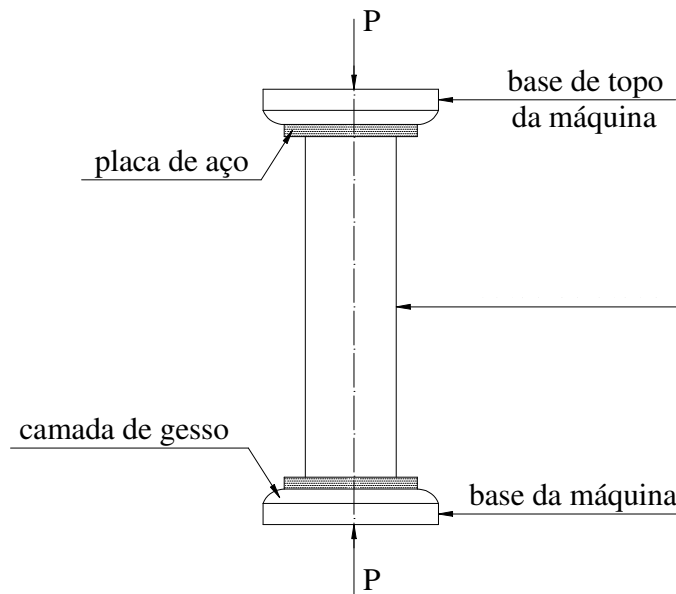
Esquema de montagem do ensaio da coluna curta.
